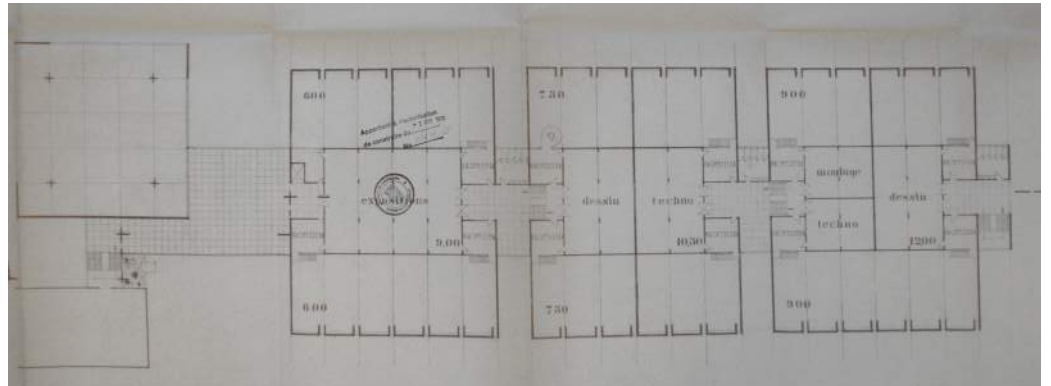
Grundriss, Zwischengeschoß (1970)
